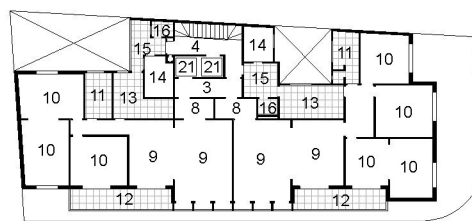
Pavto. tipo, Des: VIEIRA, M. (2008)
